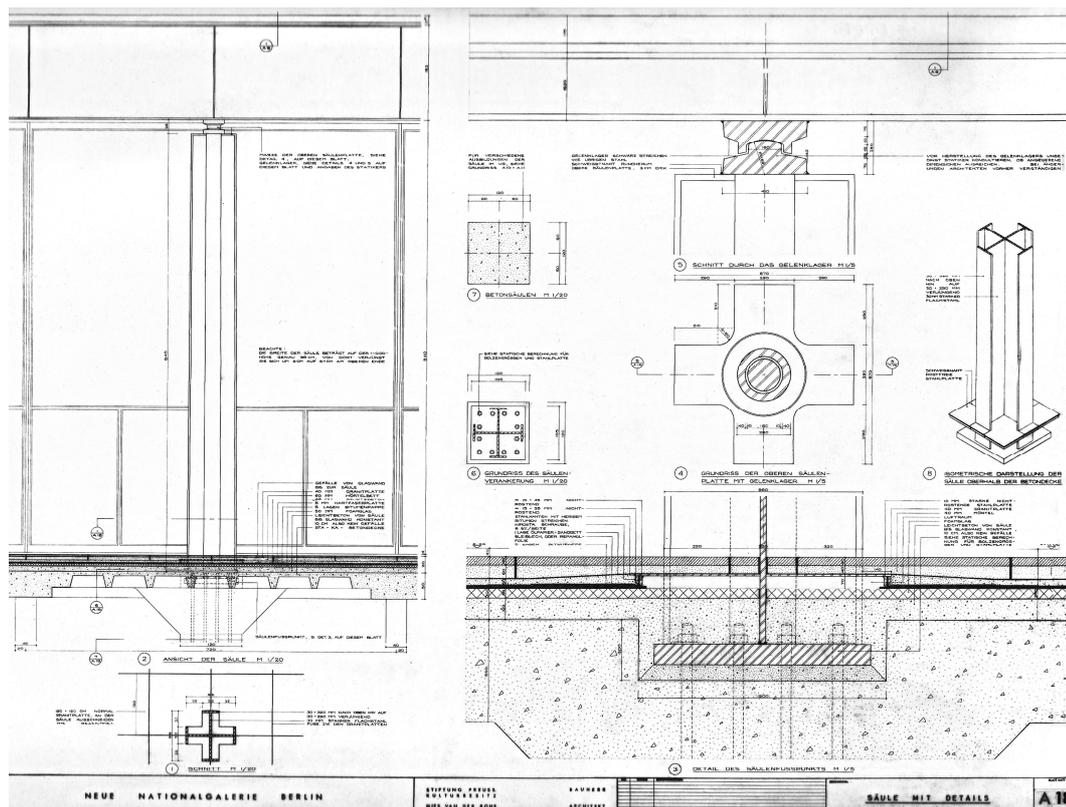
New National Gallery de Mies van der Rohe, Berlín 1962-68. Detalle de la columna metálica cruciforme y del apoyo de la cubierta.
